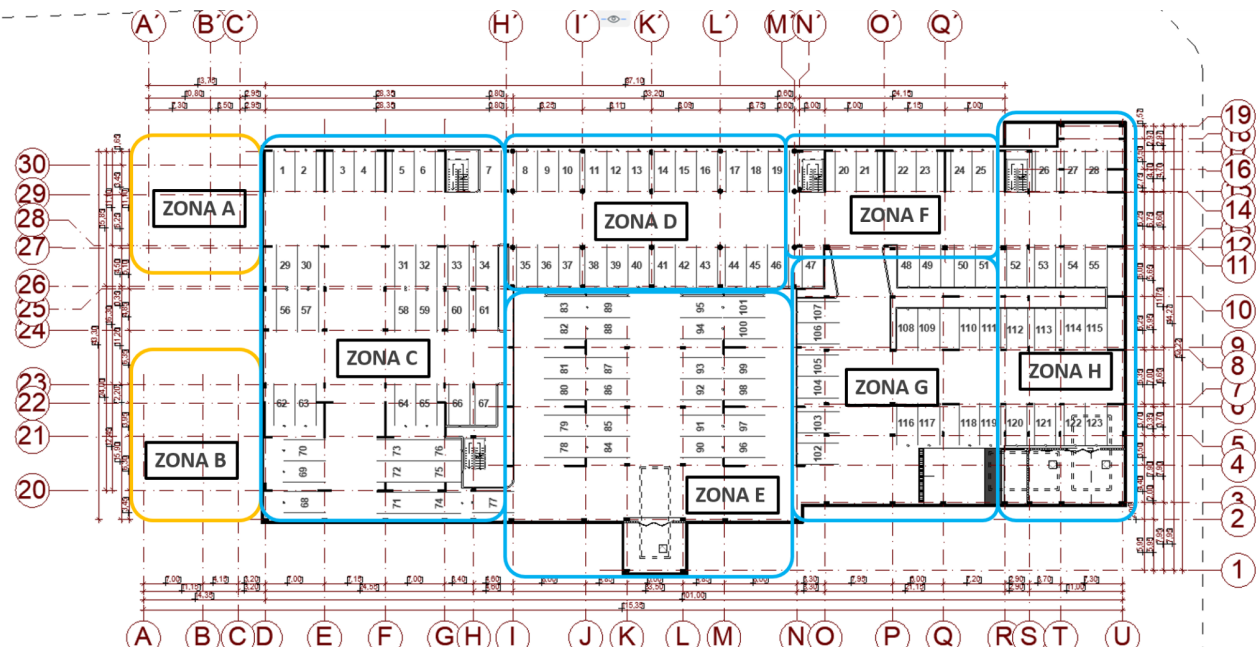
Esquema de juntas de dilatación desde Sótano - Zonas estructurales - Sistema estructural Mixto - Bueno, E. 2021
